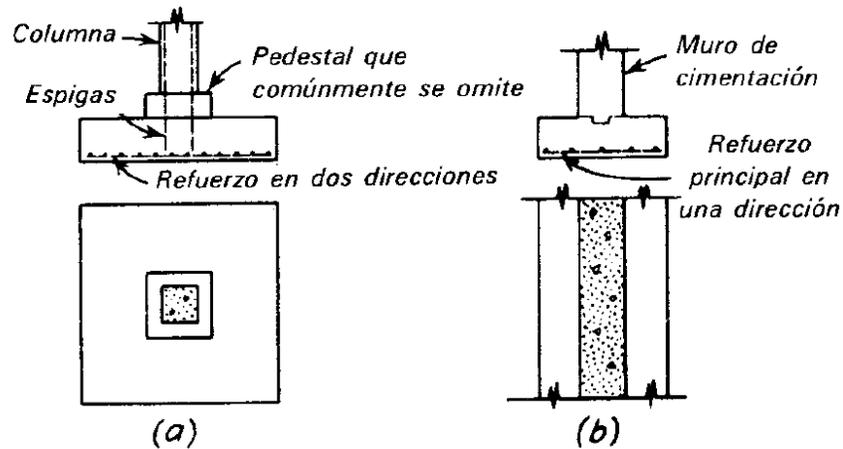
a) zapata aislada b) zapata corrida (PECK)
